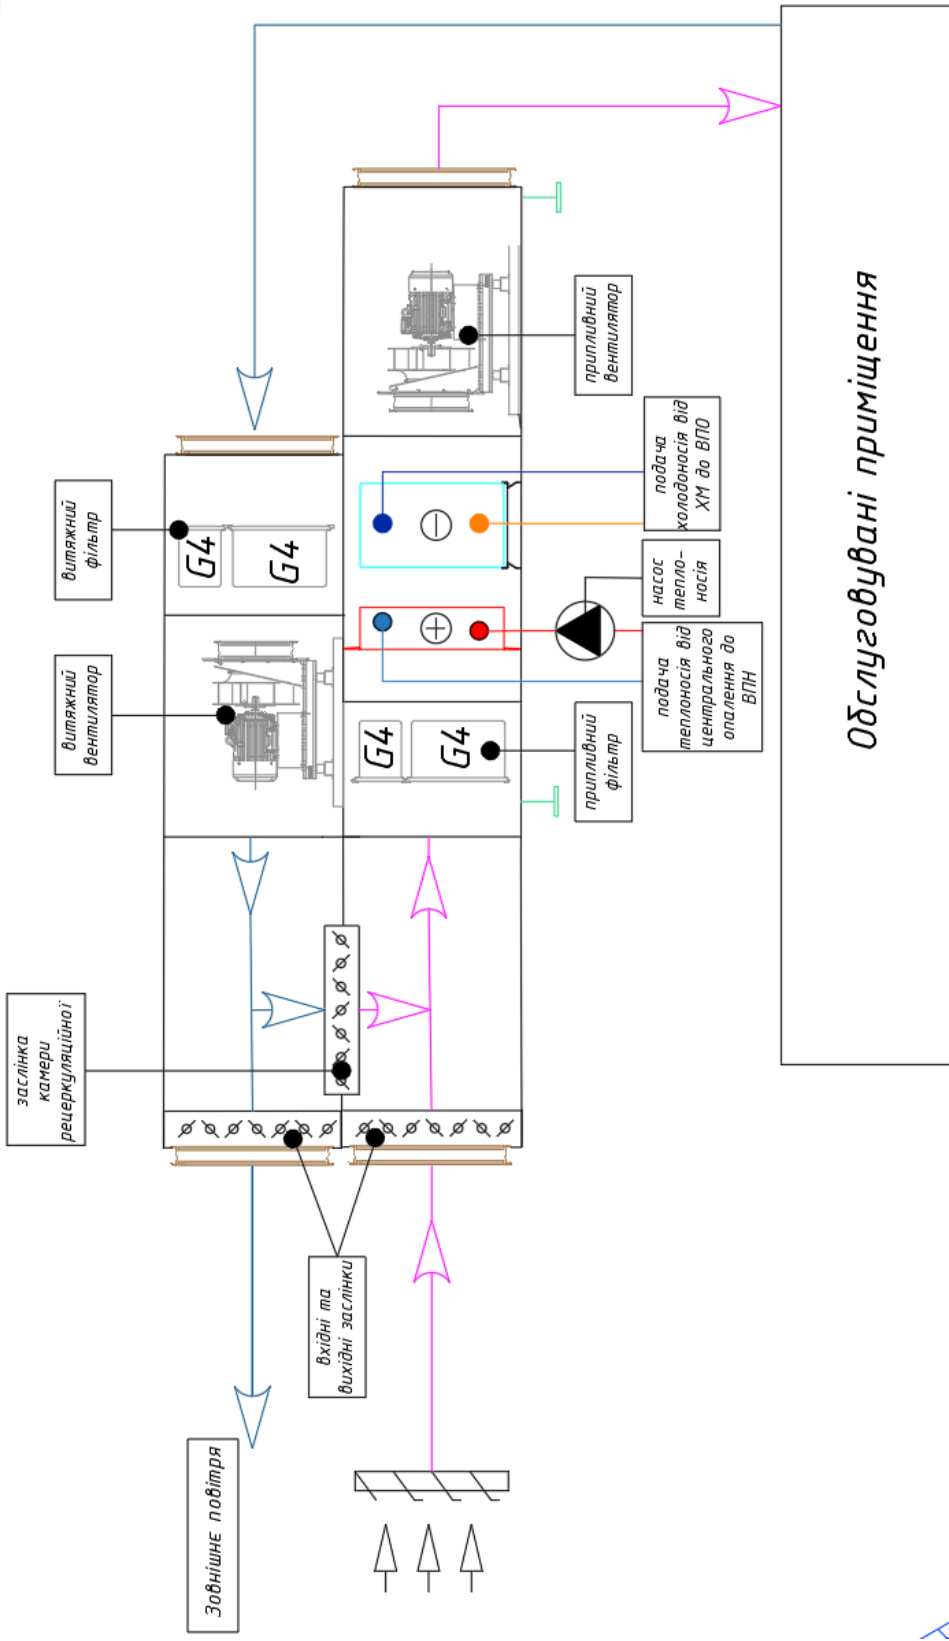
Принципова схема припливно-витяжної установки з рециркуляцією
